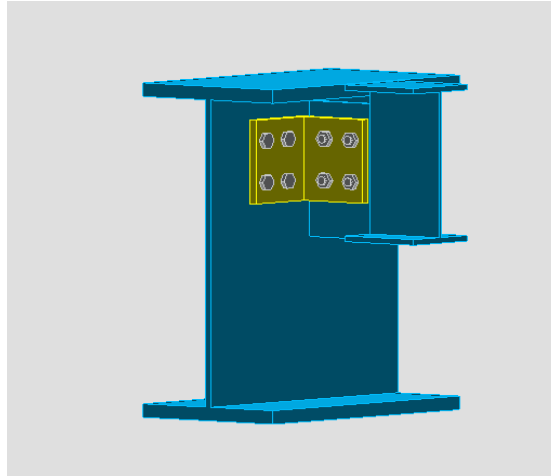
assemblage poutre solive IPE300-HEA550
